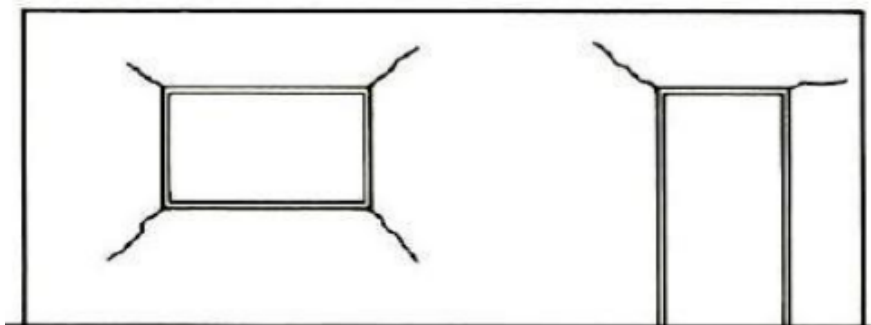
Fissuras horizontais em alvenarias devido a sobrecarga
